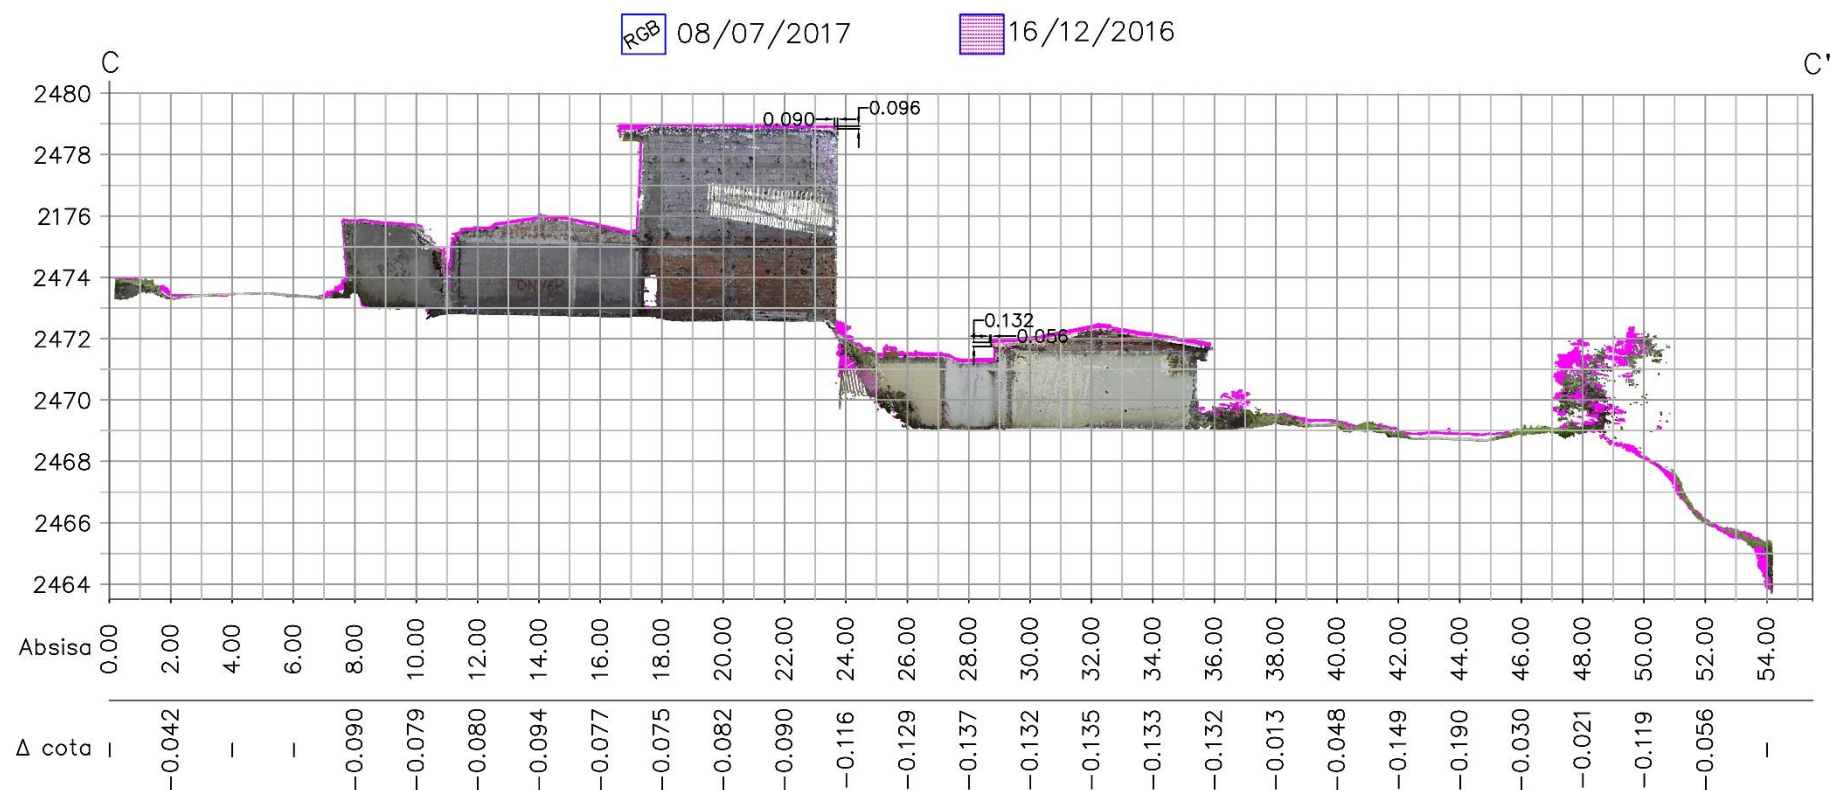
Levantamiento 1 vs levantamiento 3, perfil C-C'.
